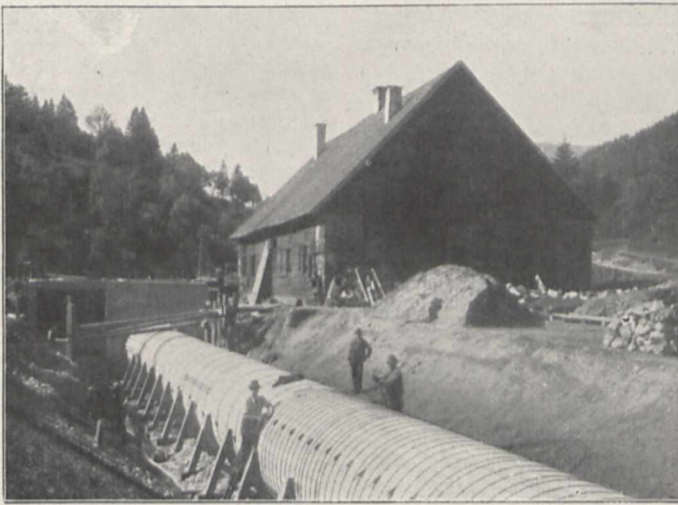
Muffen- und flanschenlose Holzrohrleitung
